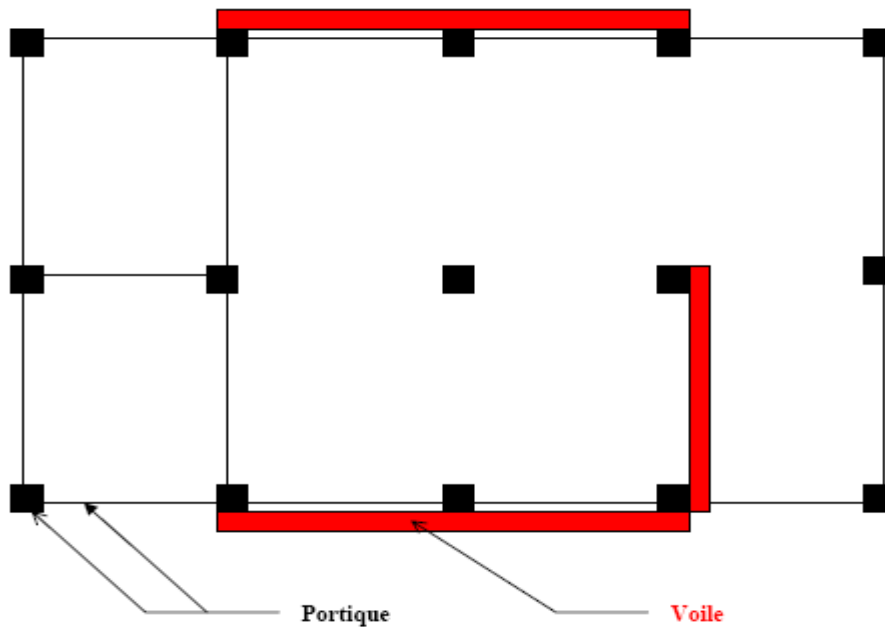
Structure mixte avec des voiles couplées à des portiques
